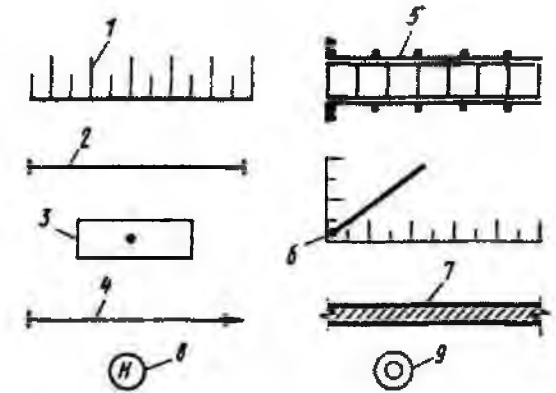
Условные обозначения: 1 — откос котлована; 2 — инвентарная металлическая скамейка конструкции Мосоргстроя (арх. № 4264); 3 — знак закрепления разбивочных осей; 4 — направление движения экскаватора; 5 — лестница для спуска в котлован с боковым ограждением высотой 1 м; 6 — колья, забиваемые по контуру котлована; 7 — грунт, выбираемый вручную; 8 — начало работы экскаватора; 9 — окончание работы экскаватора
